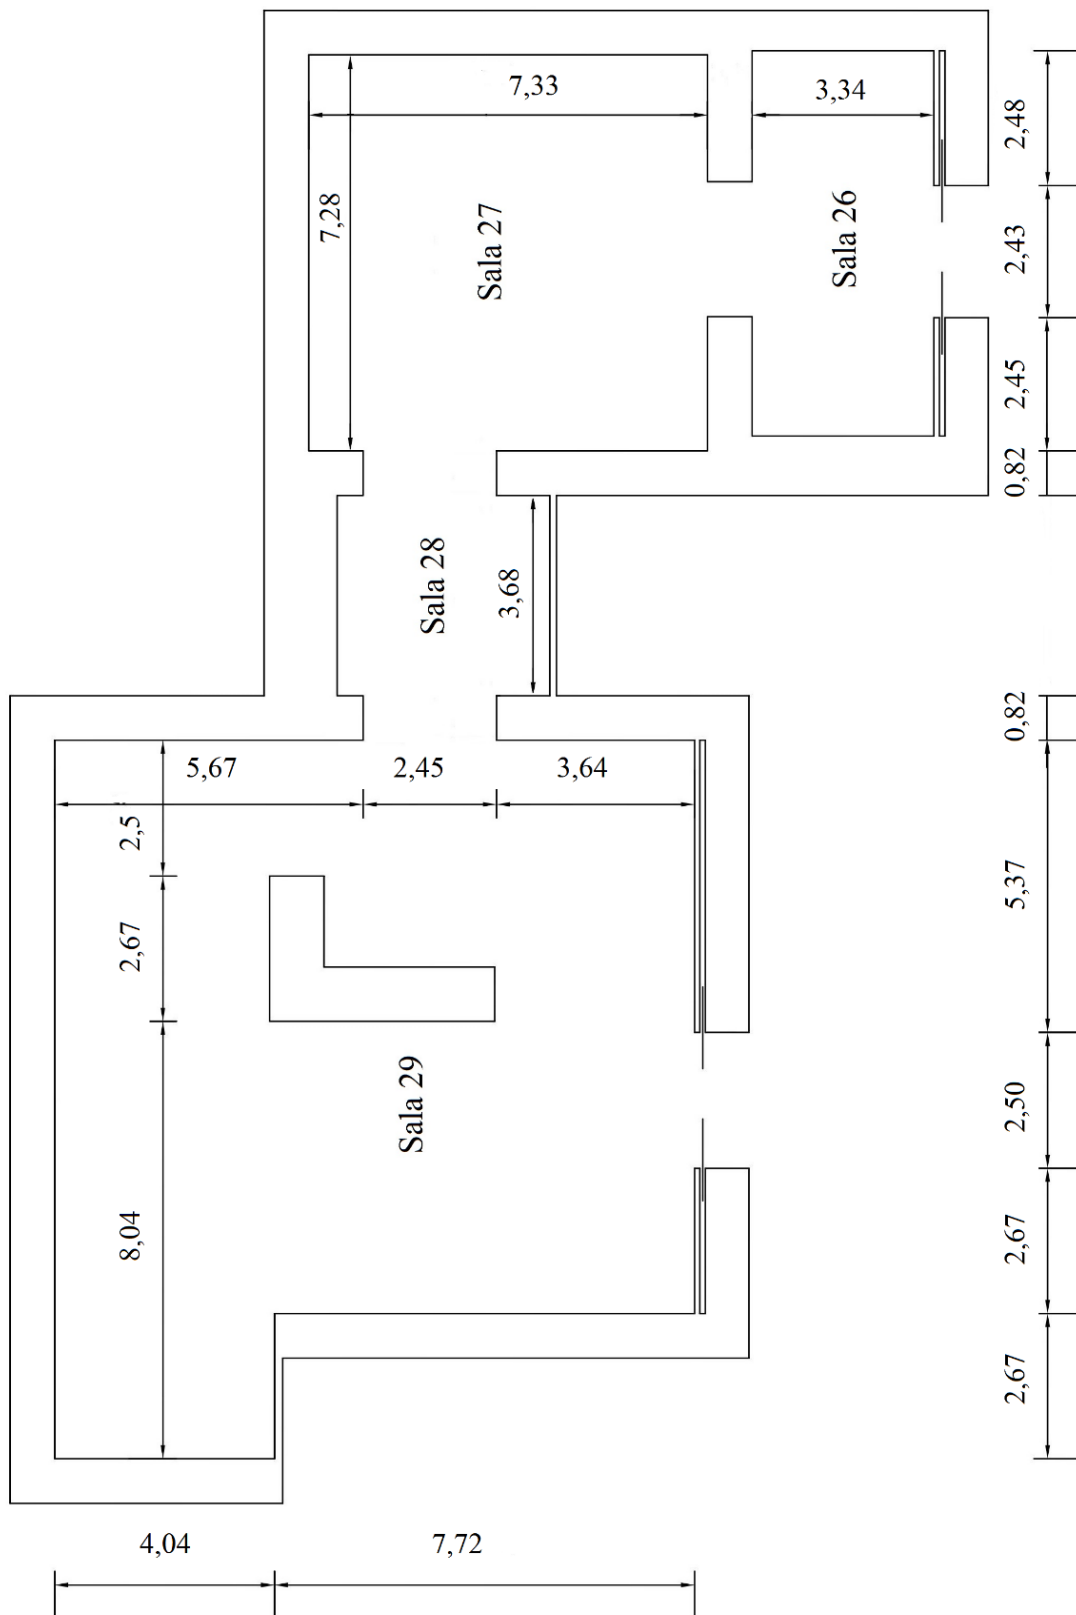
Planta das salas de exposição de ourivesaria portuguesa do MNAA, com as dimensões.
